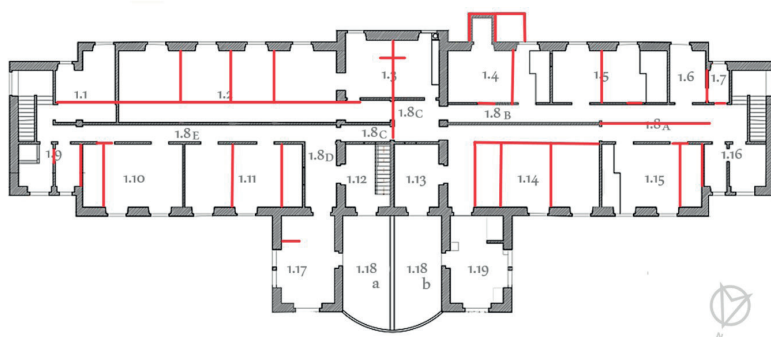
Planta do piso superior, indicando a vermelho as alterações (remoções e adições) efetuadas ao longo da utilização do espaço (MEDEIROS 2019).
